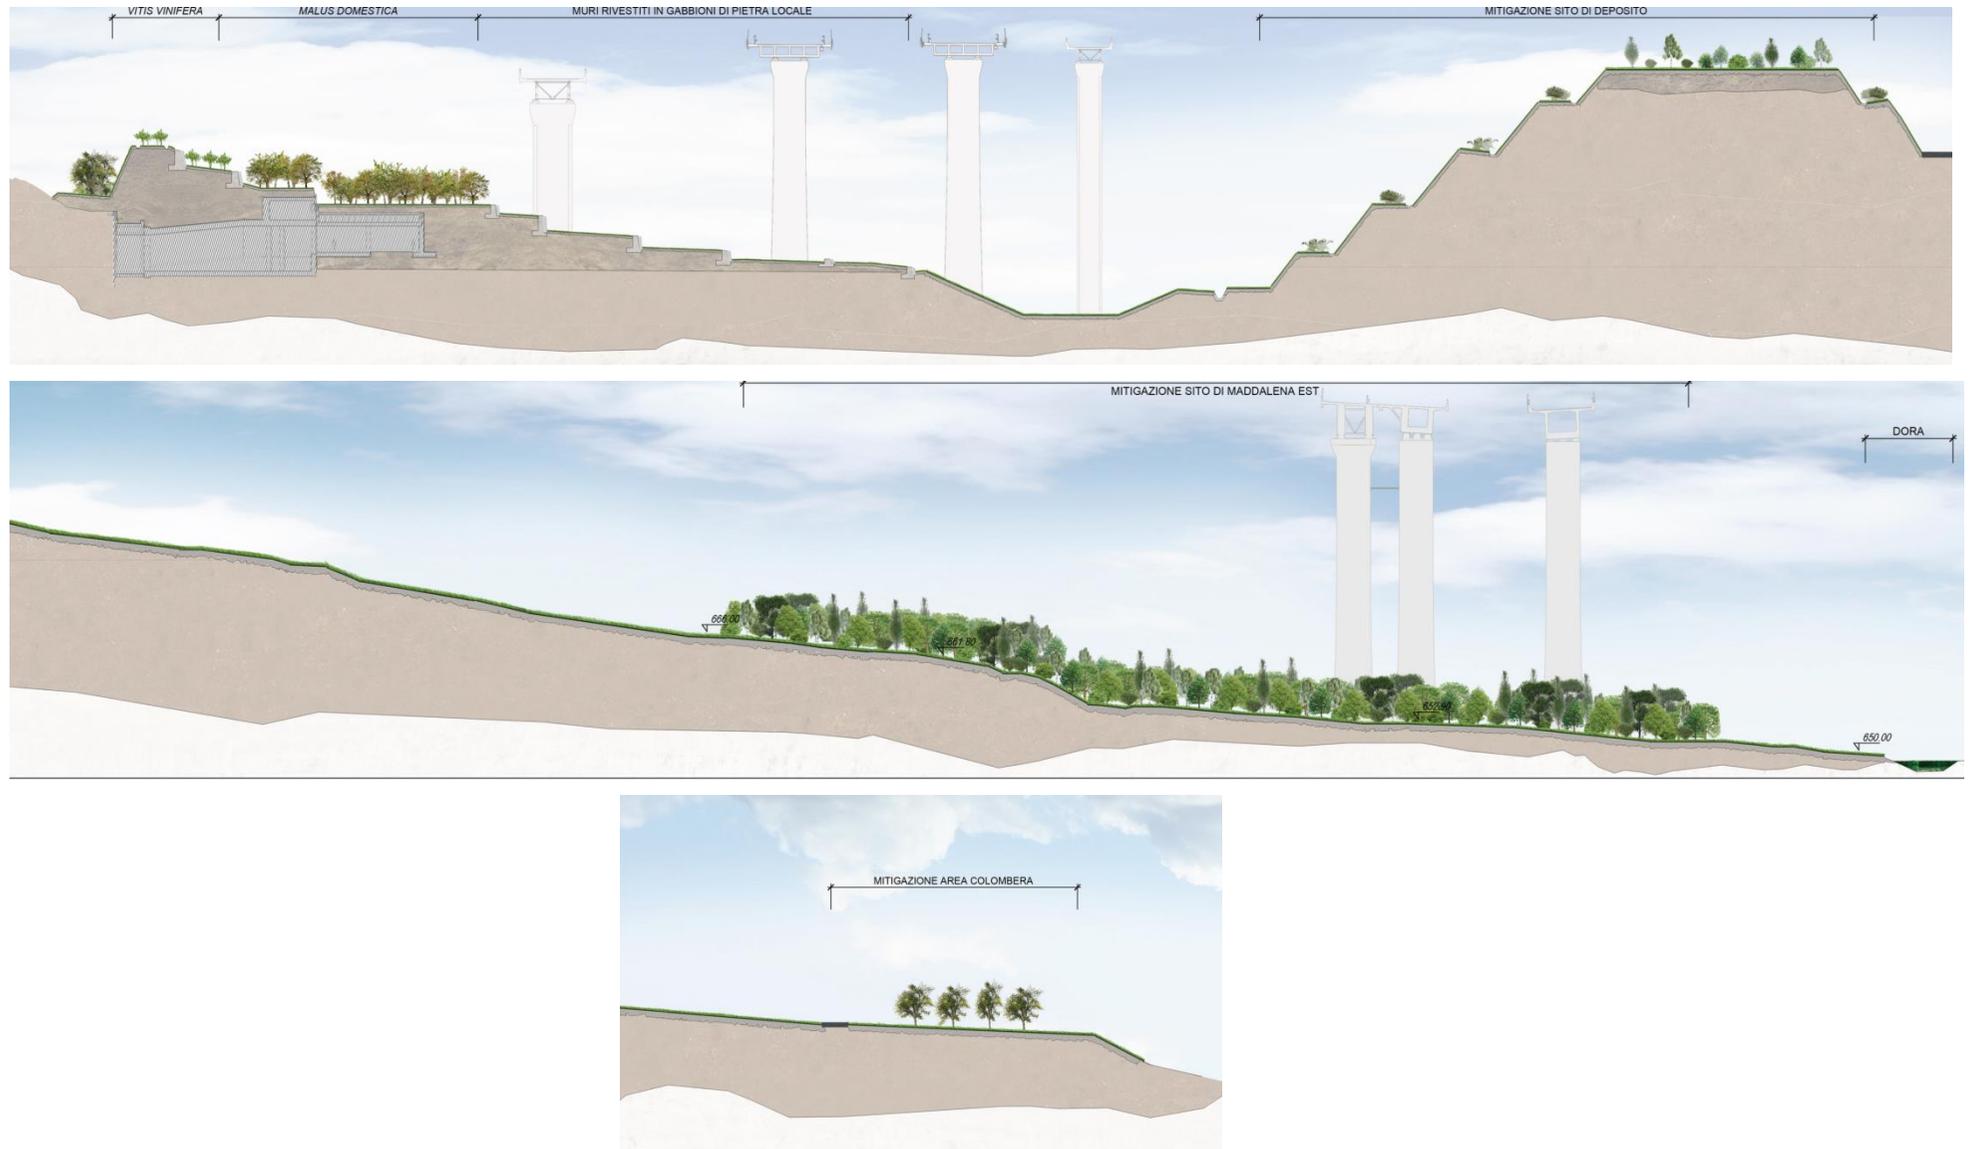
Progetto di Variante (PRV_TS3_C3C_0205: Interventi di ripristino finale_cantiere della Madalena_sezioni)
